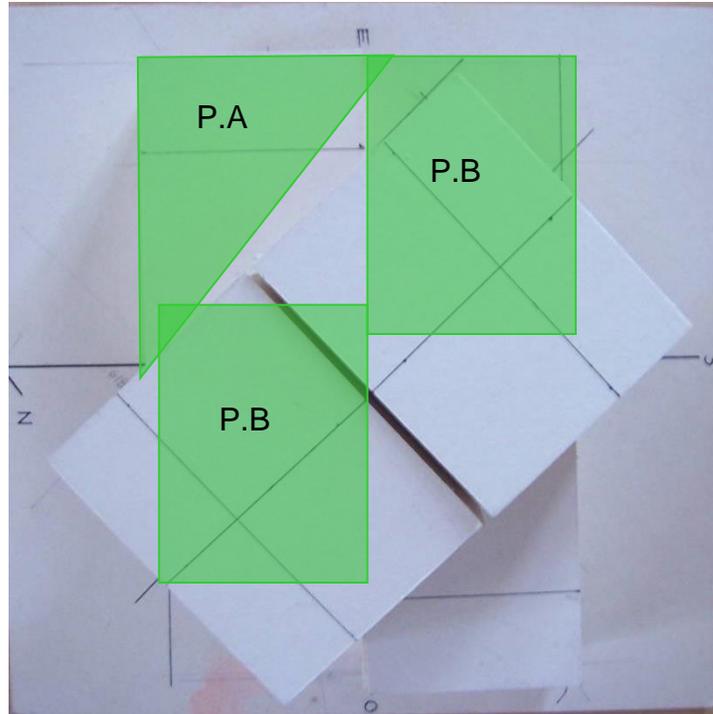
Vista en planta de conjunto con cuatro volúmenes diferentes.
